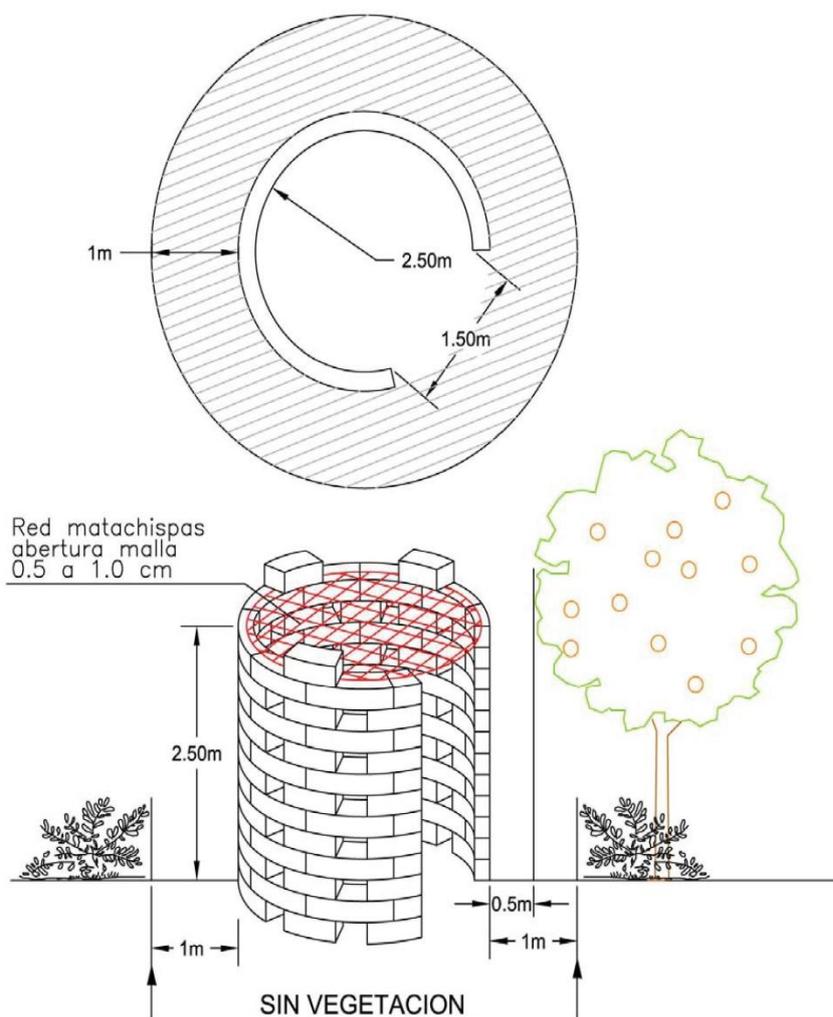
Planta y alzado de un quemador debidamente acondicionado.
